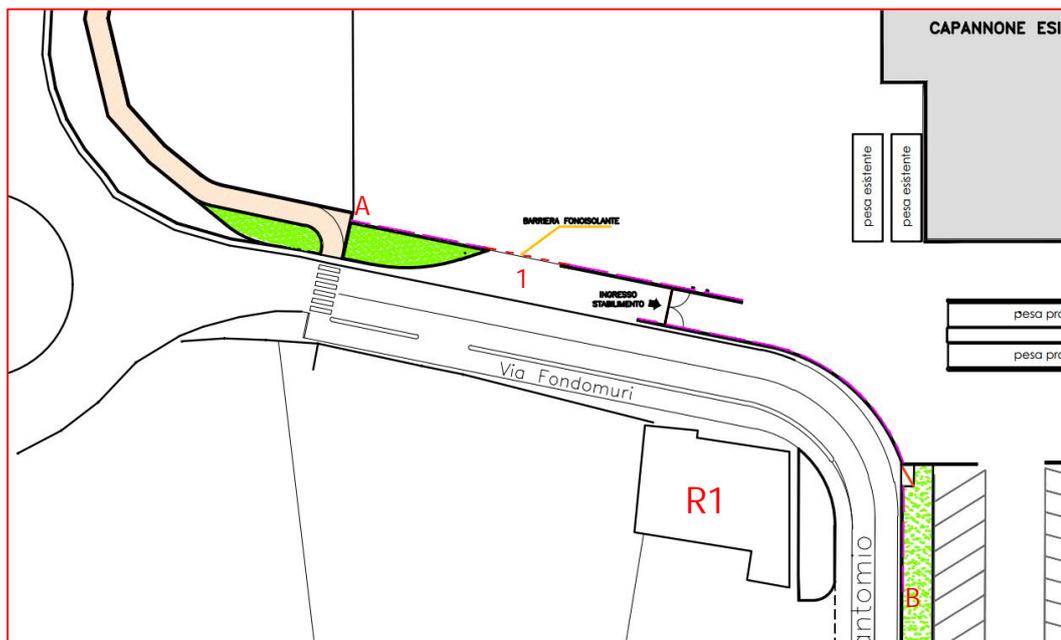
CONFIGURAZIONE PLANIMETRICA DELLA BARRIERA ACUSTICA AREA INGRESSO IMPIANTO
